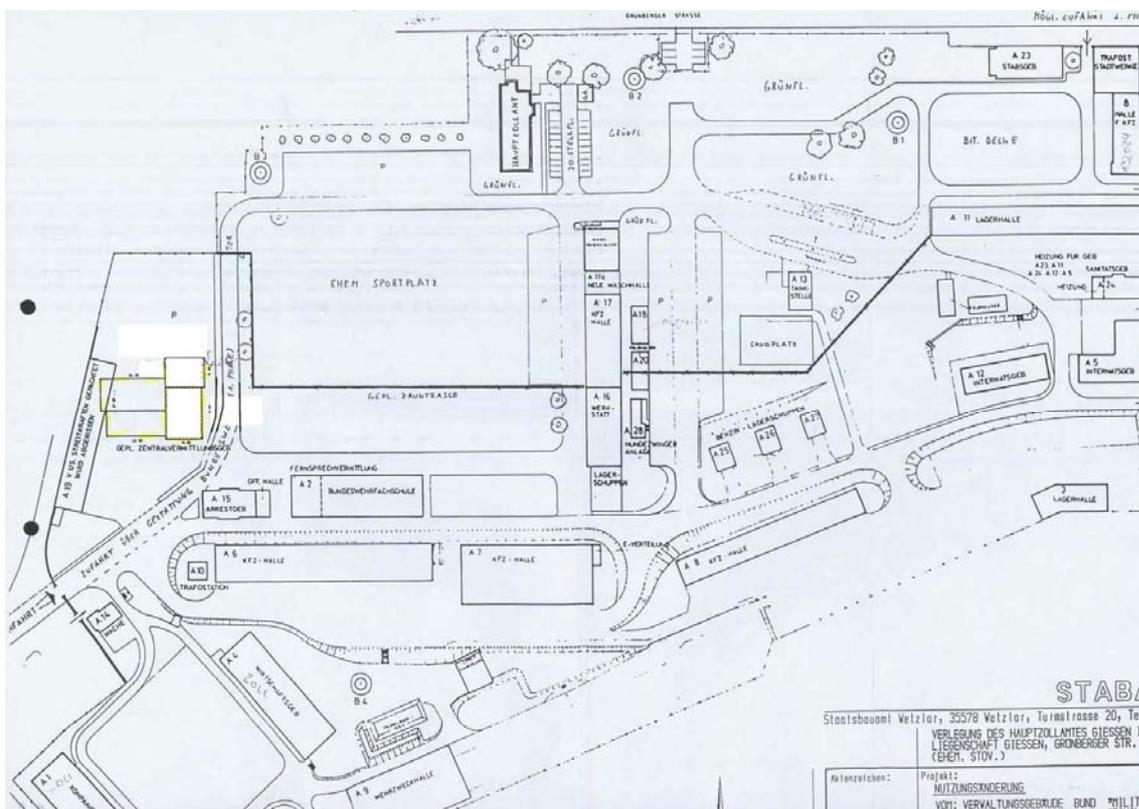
Bestandslageplan mit Gebäudenummern, Quelle: Hessisches Baumanagement
